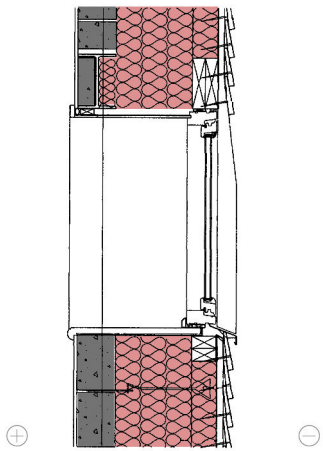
Corte da fachada da Comunidade Bedzed em Londres.
